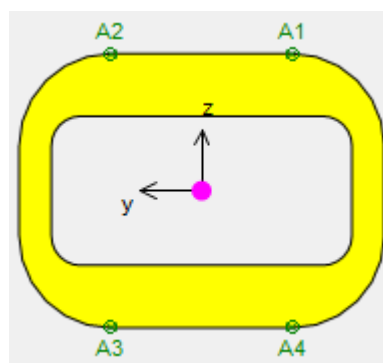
Sezione trasversale pila-spalla.
